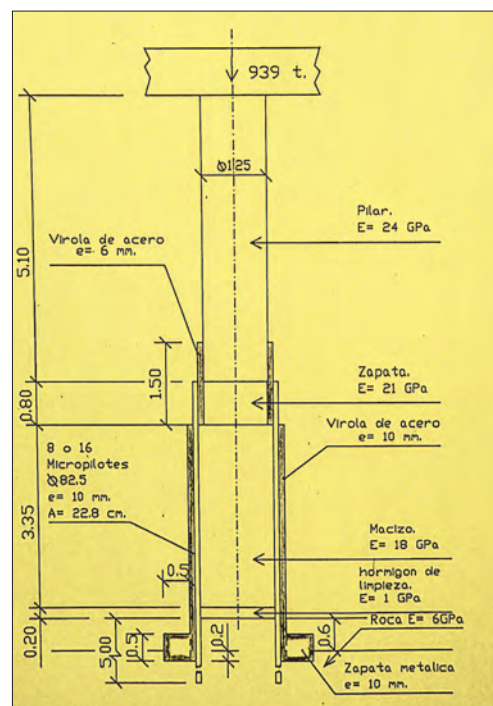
CIMENTACIÓN RECORTADA Y ZUNCHADA CON CHAPAS METÁLICAS.
